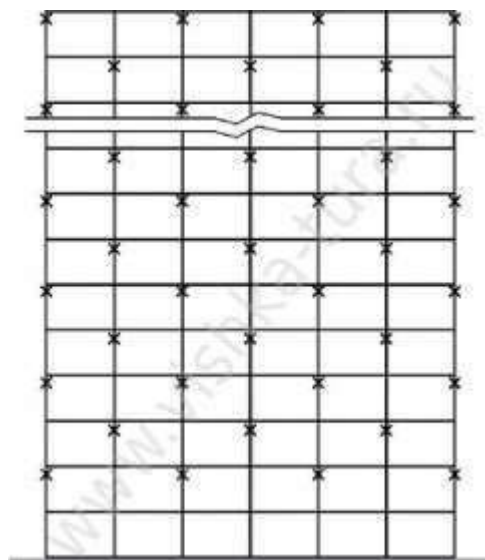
Схема установки пробок для крепления лесов к стене (× - место крепления)
